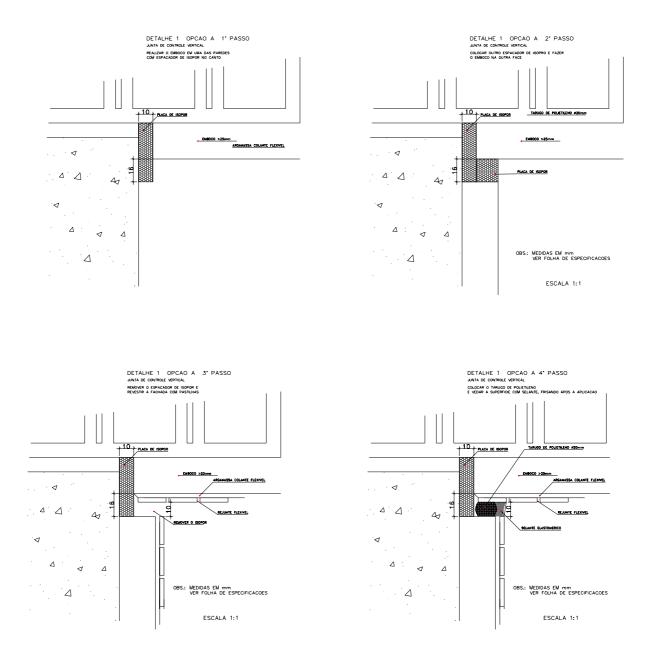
Junta de movimentação do revestimento de uma parede de fachada.
